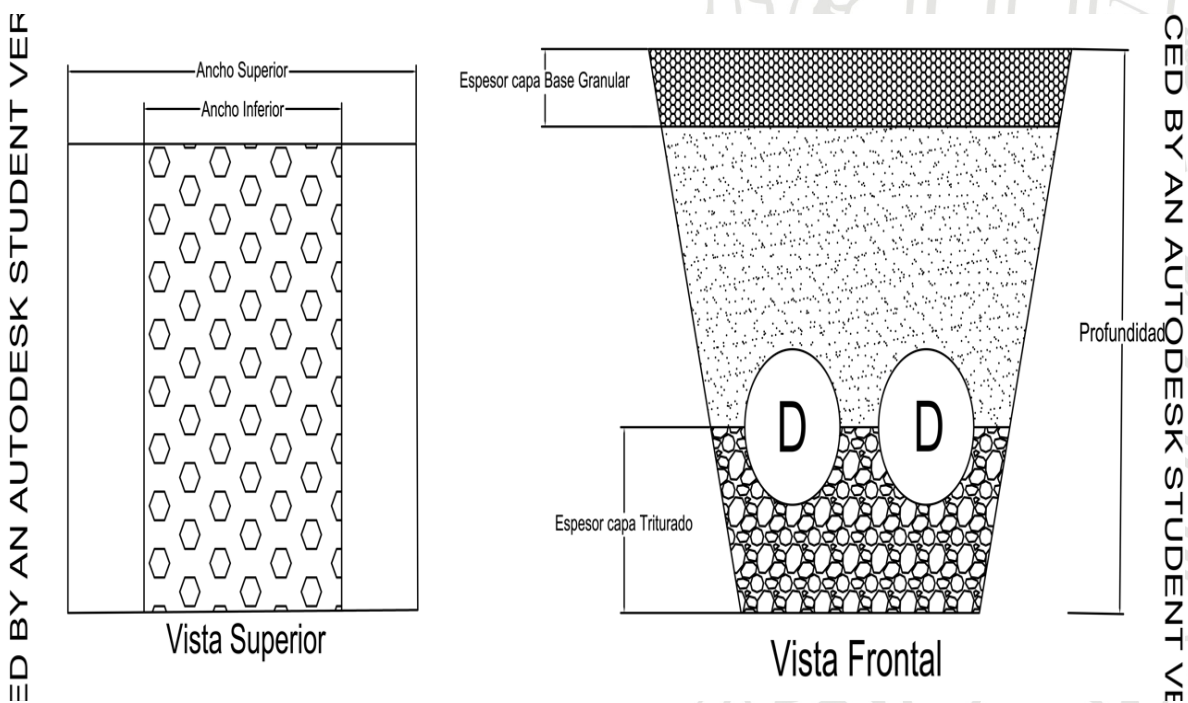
Sección típica de las excavaciones de la obra, vista frontal y superior.
